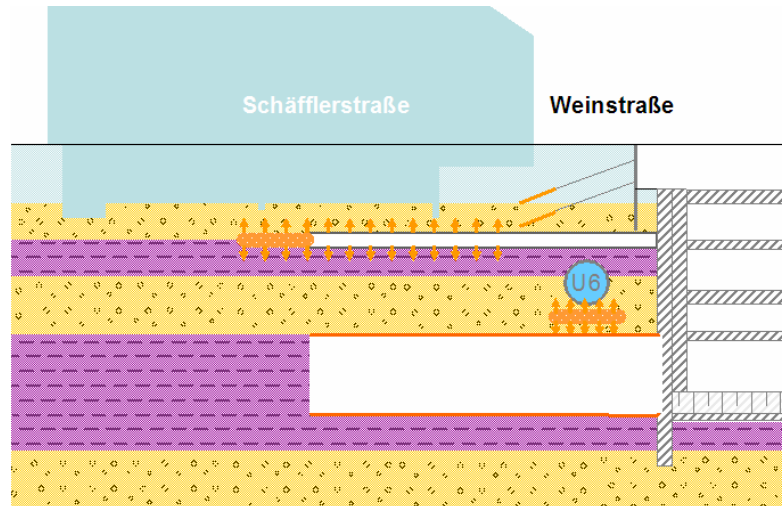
geplante Hebungsinjektionen unterhalb der U-Bahn und der vorhandenen Bebauung
